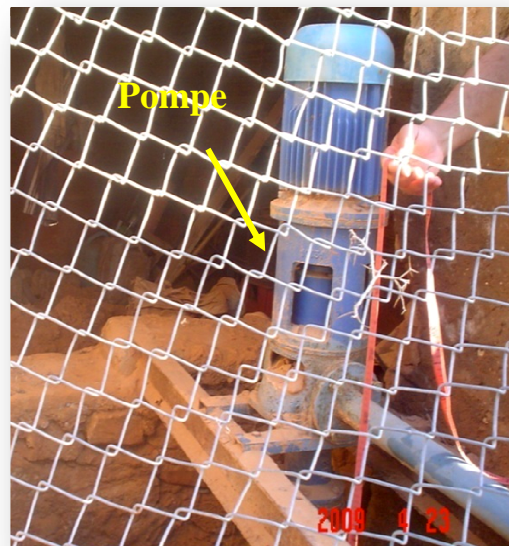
Puits en pierre réhabilité en mortier.
